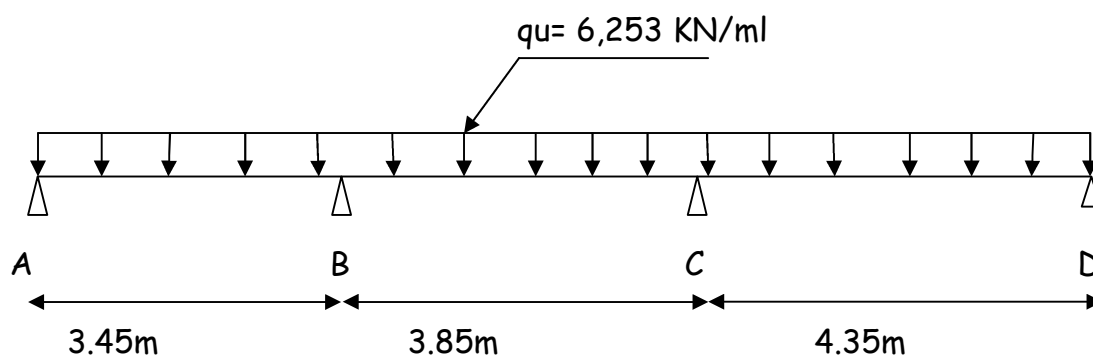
Schéma statique de la poutrelle continue reposant sur 4 appuis.
